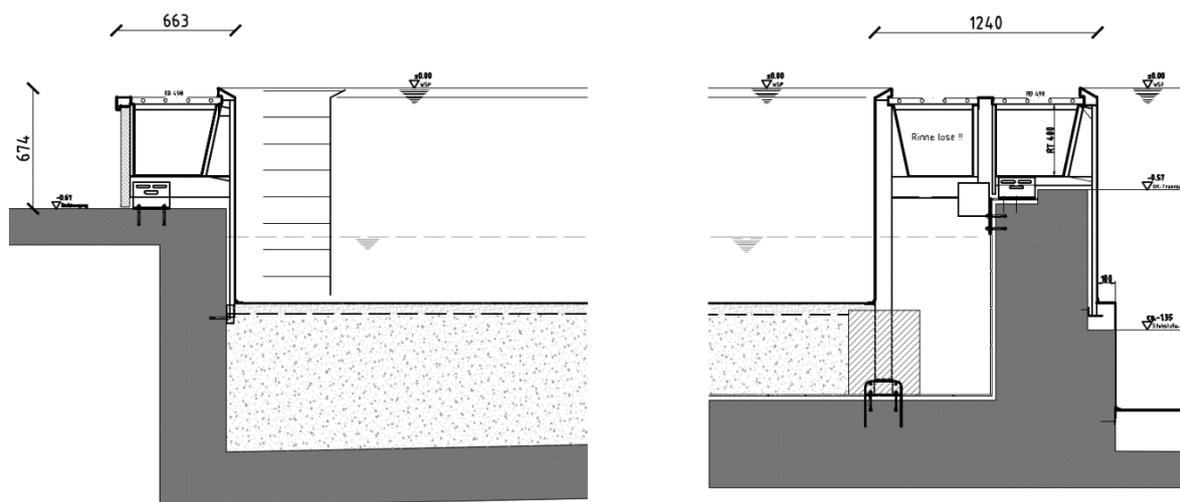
und 22: Grundriss und Schnitt neues Edelstahlbecken
